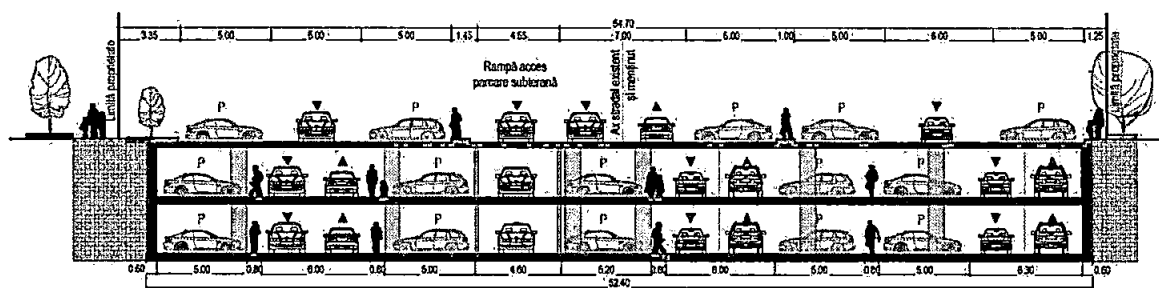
Profilul stradal propus Aleea Daliei – varianta 2
